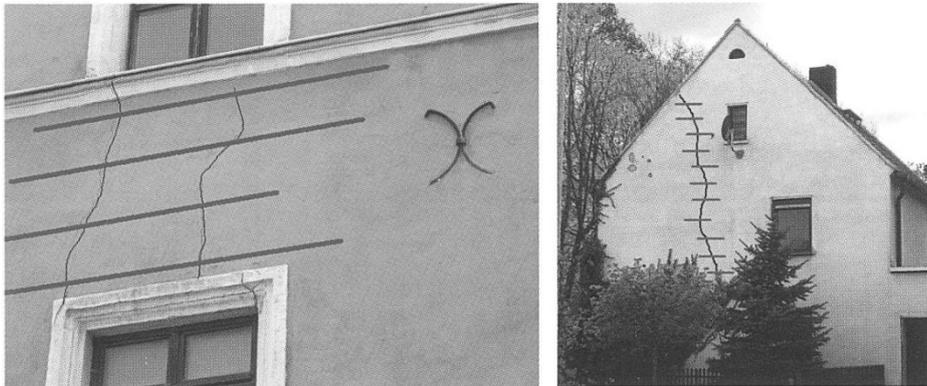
Примеры усиления кирпичной кладки спиральными анкерами
